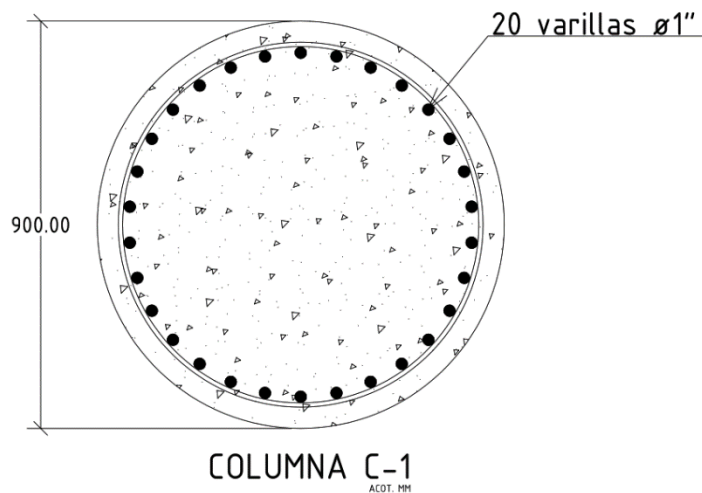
Vista esquemática de la sección. (Fuente autoría propia, 2019)
